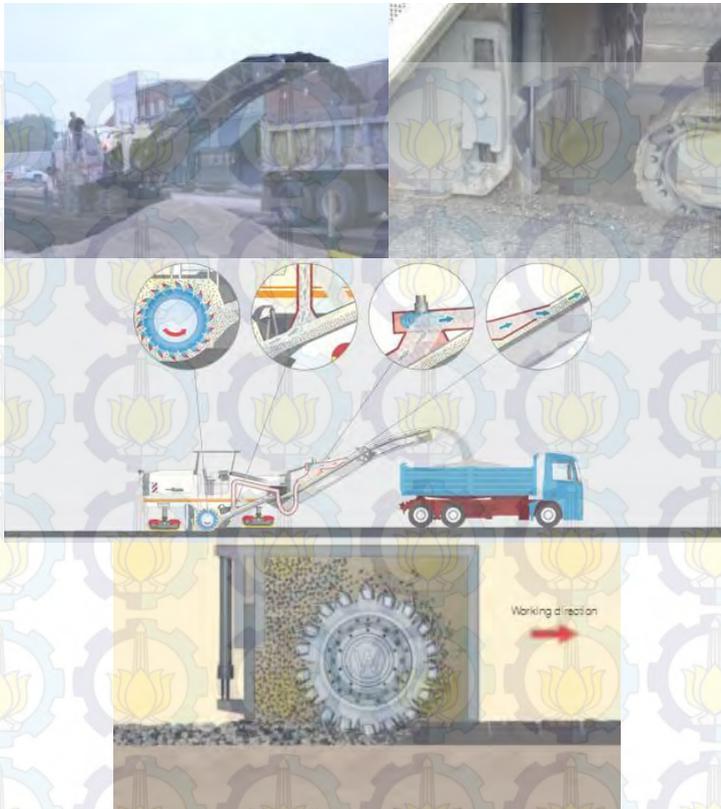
Reclaimed Asphalt Pavement (RAP)
